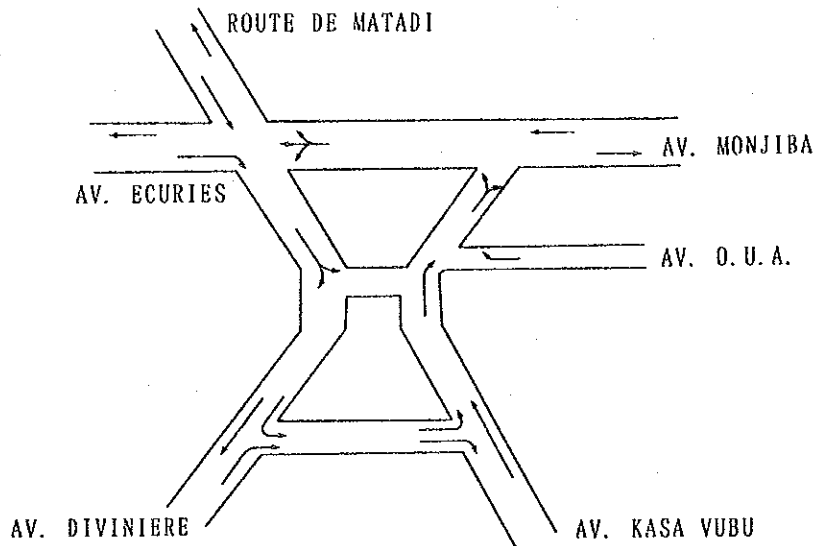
Cas 1 plan d'aménagement du carrefour
